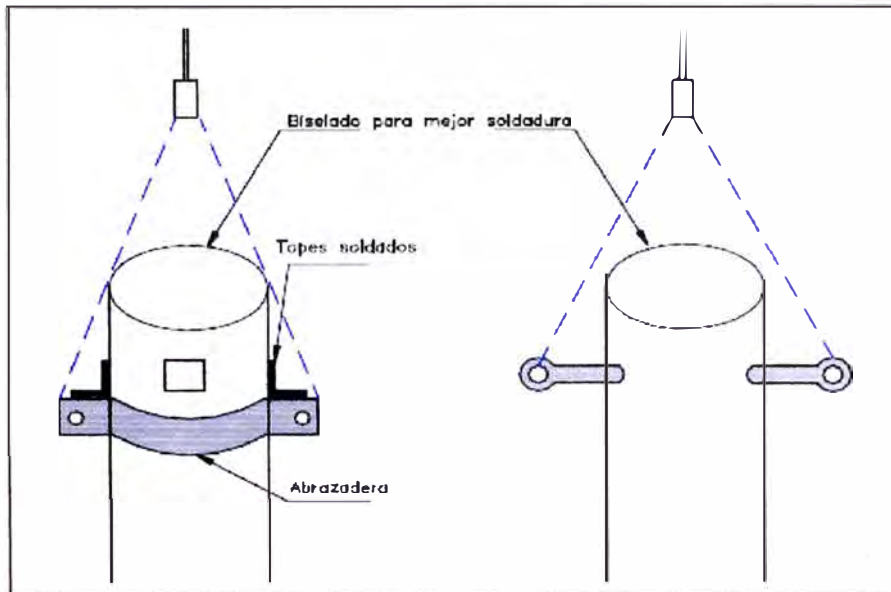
ESQUEMA DE IZAJE - COLUMNA DE ENTUBADO
